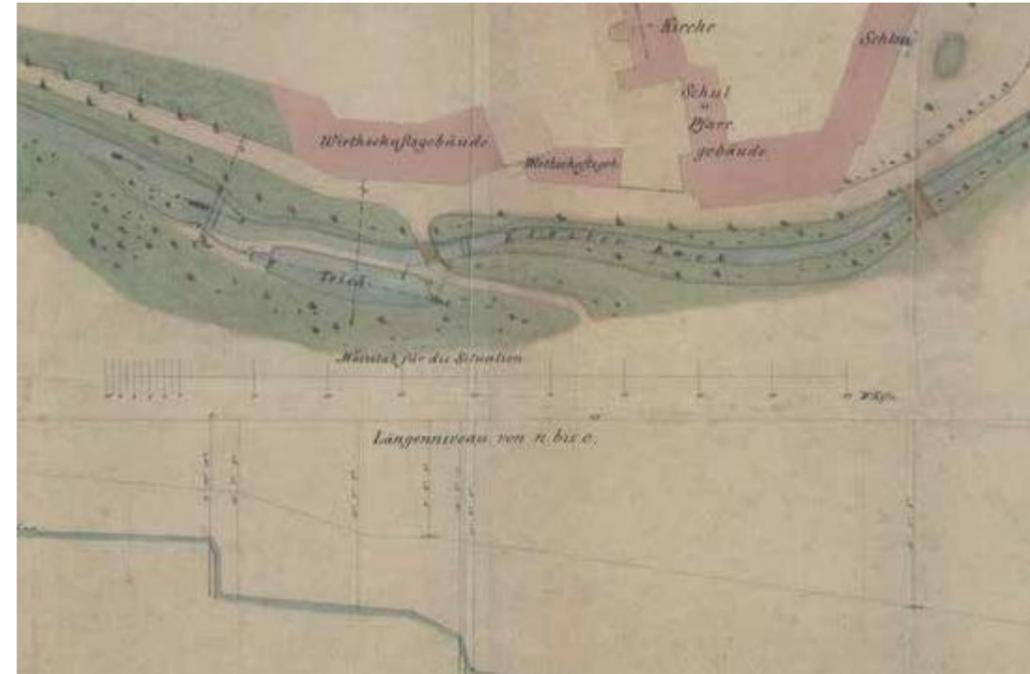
Lageplan zur Anlegung des Teiches unter Jakob Rappaport, 1863.
